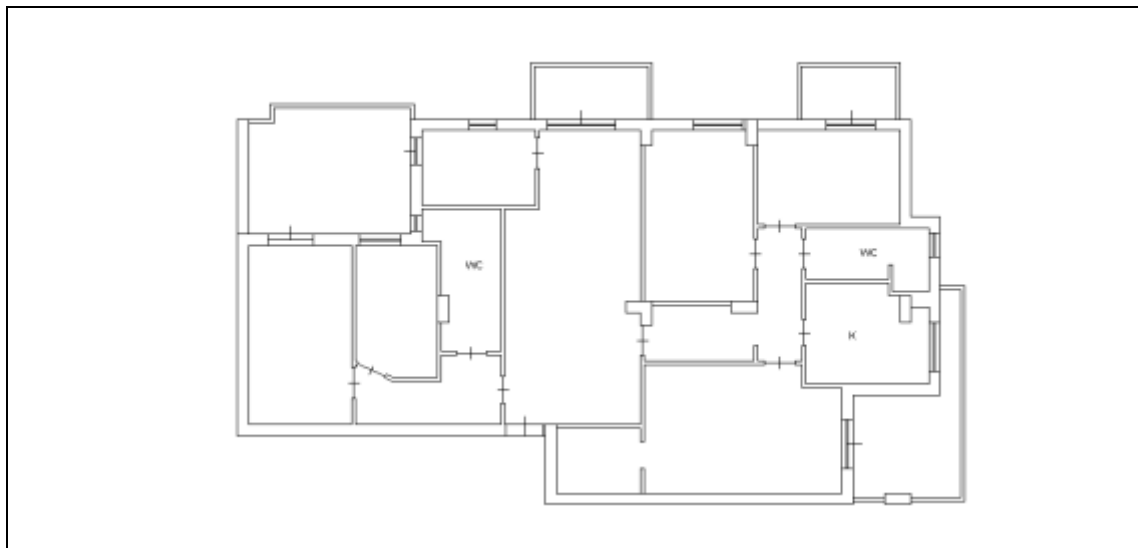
Nuova planimetria catastale "sub61" Lotto2 – agli atti
